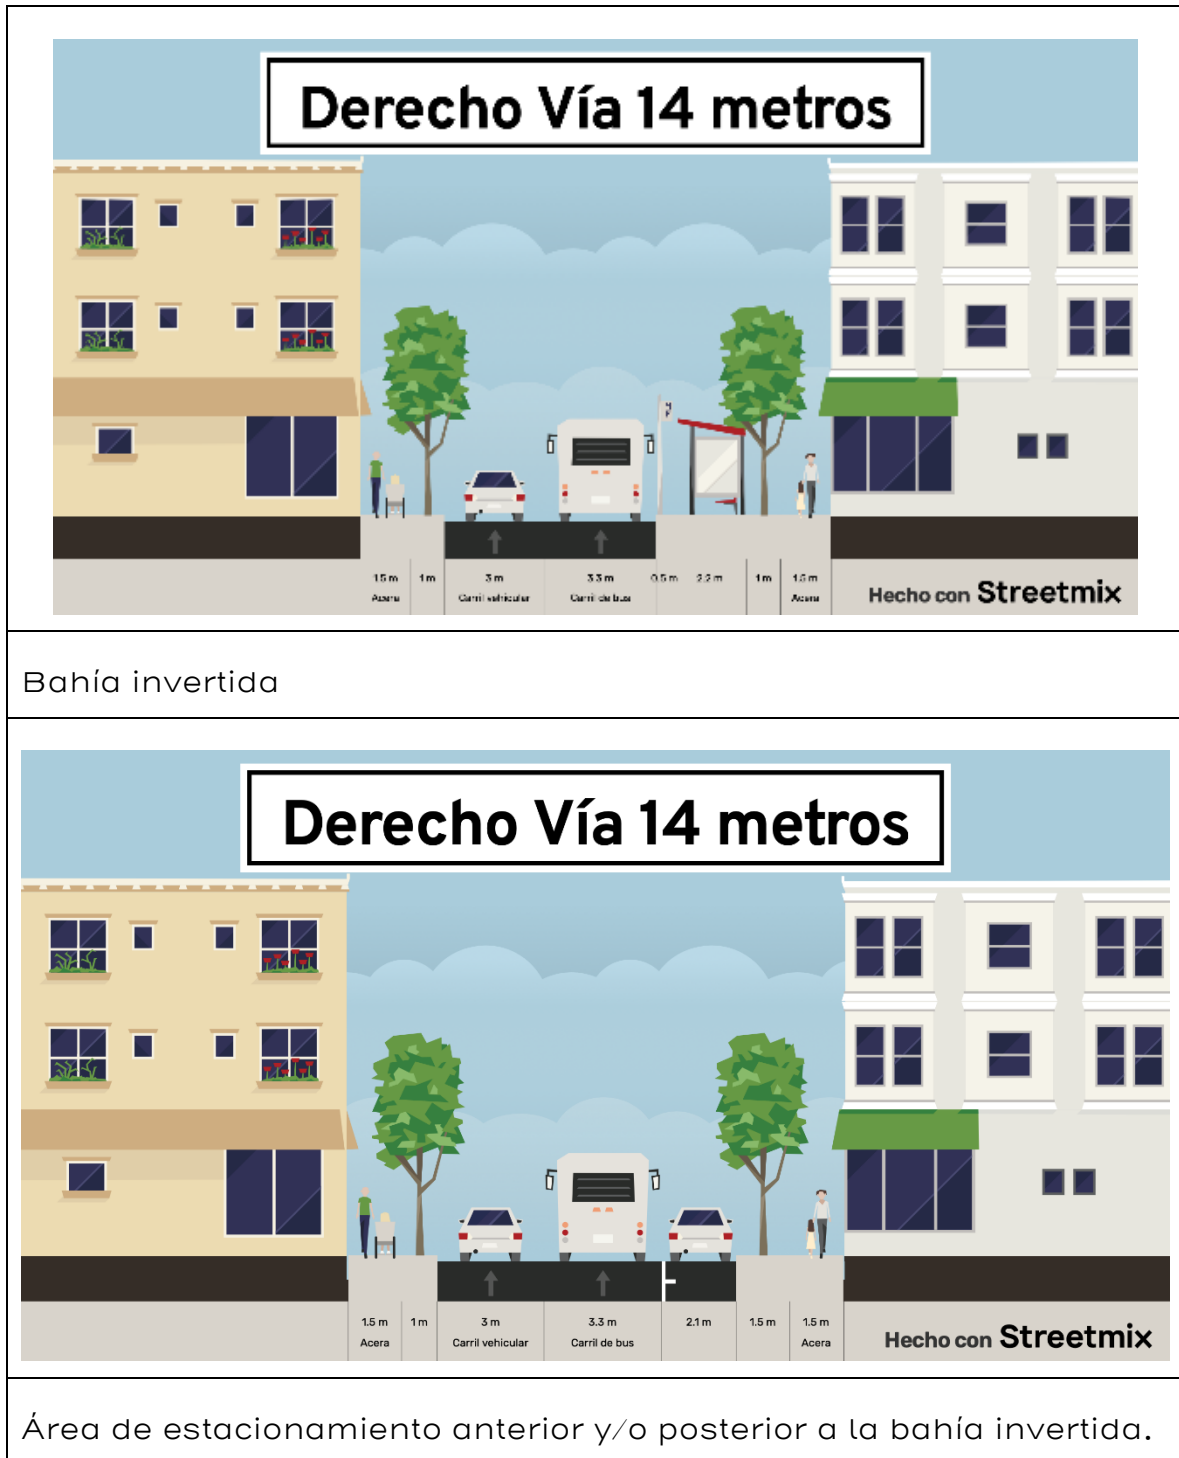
Derecho de vía 14 metros, con escampadero con bahía externa,
